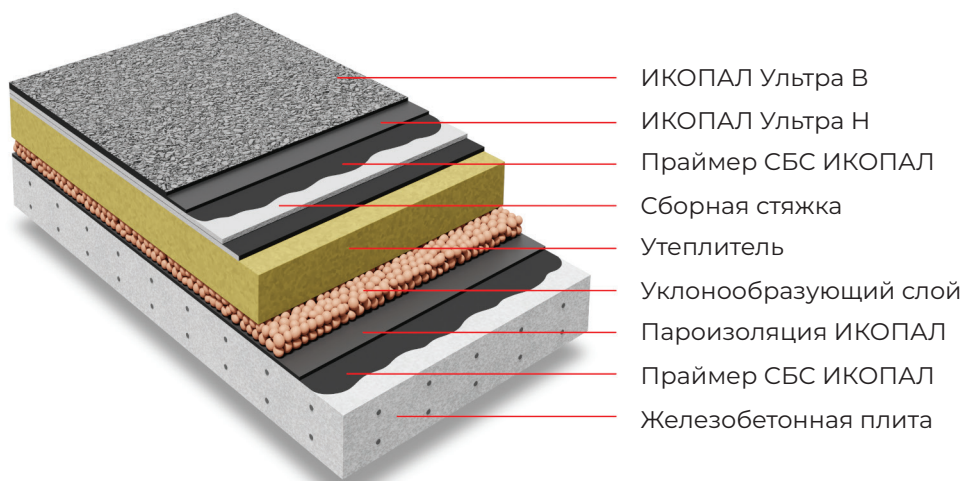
Вариант неэксплуатируемой кровли с двухслойным кровельным ковром
